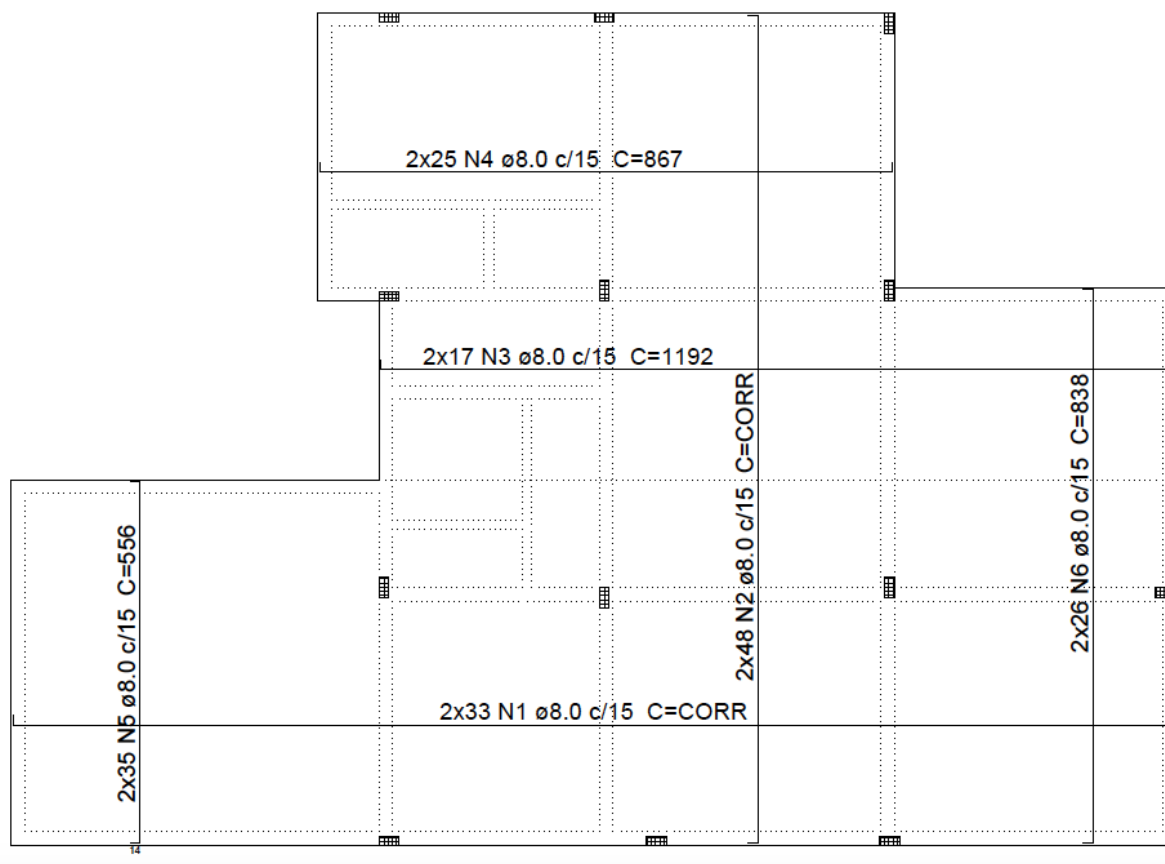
Detalhamento Armadura Positiva Dimensionada
